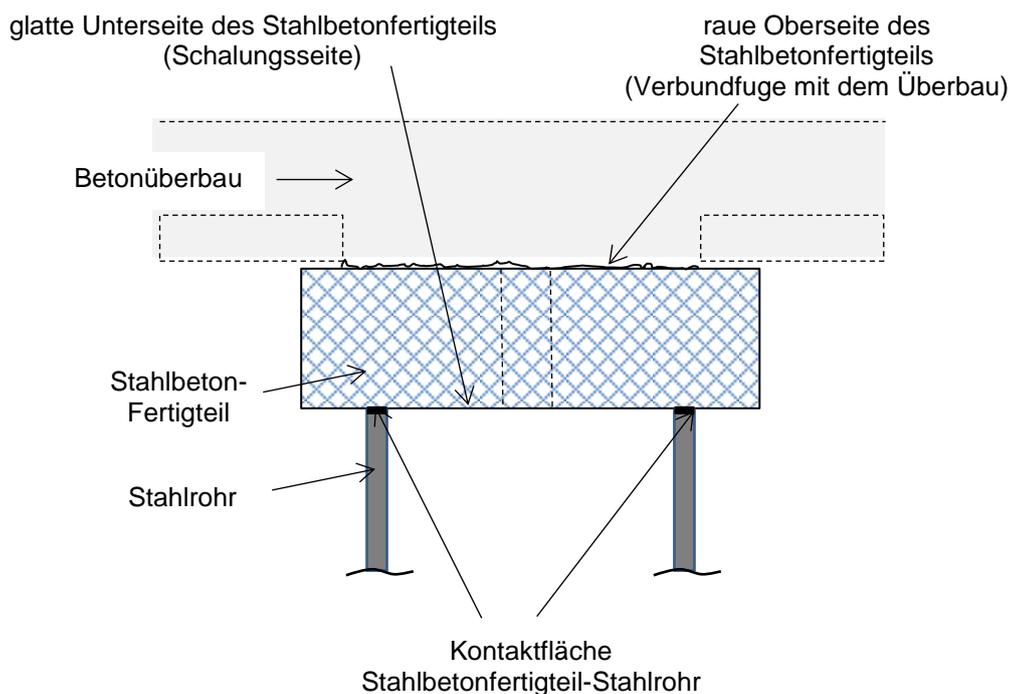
Kennzeichnung der "rauen" Oberseite des Stahlbetonfertigteiles
